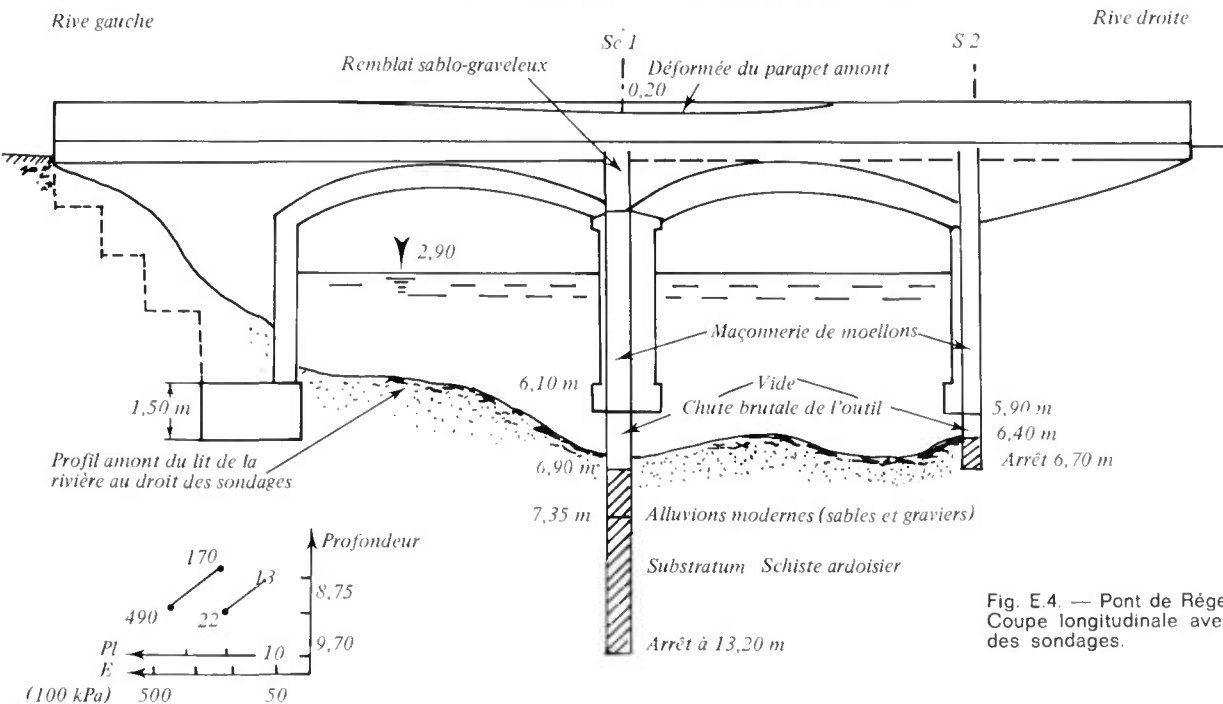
Pont de Régereau. Coupe longitudinale avec report des sondages.
